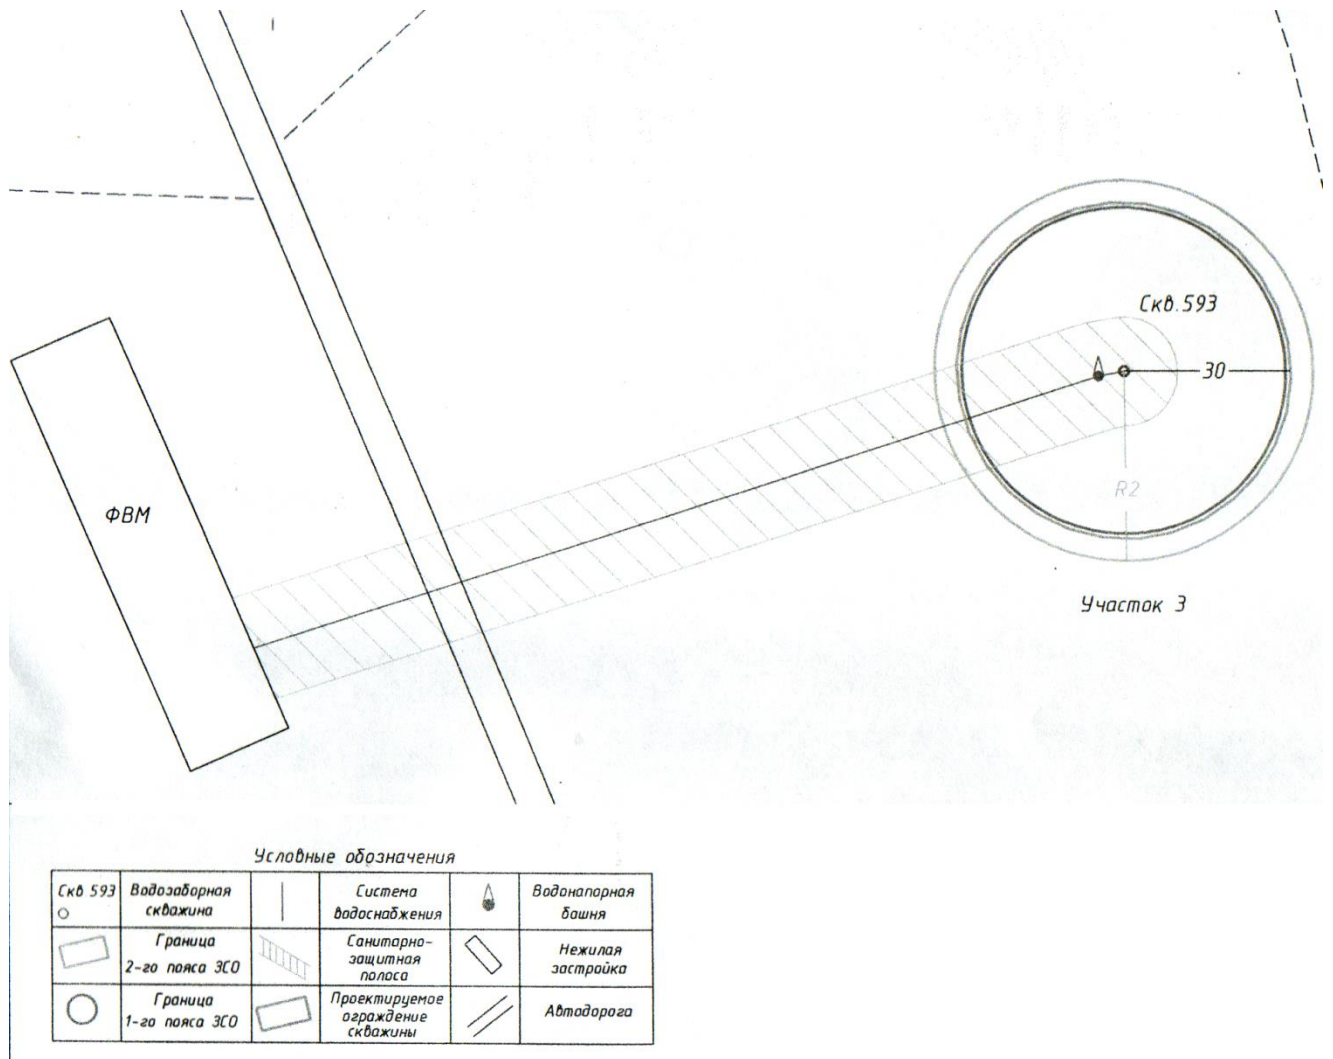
План 1-го, 2-го и 3-го поясов ЗСО и санитарно-защитной полосы водопровода
